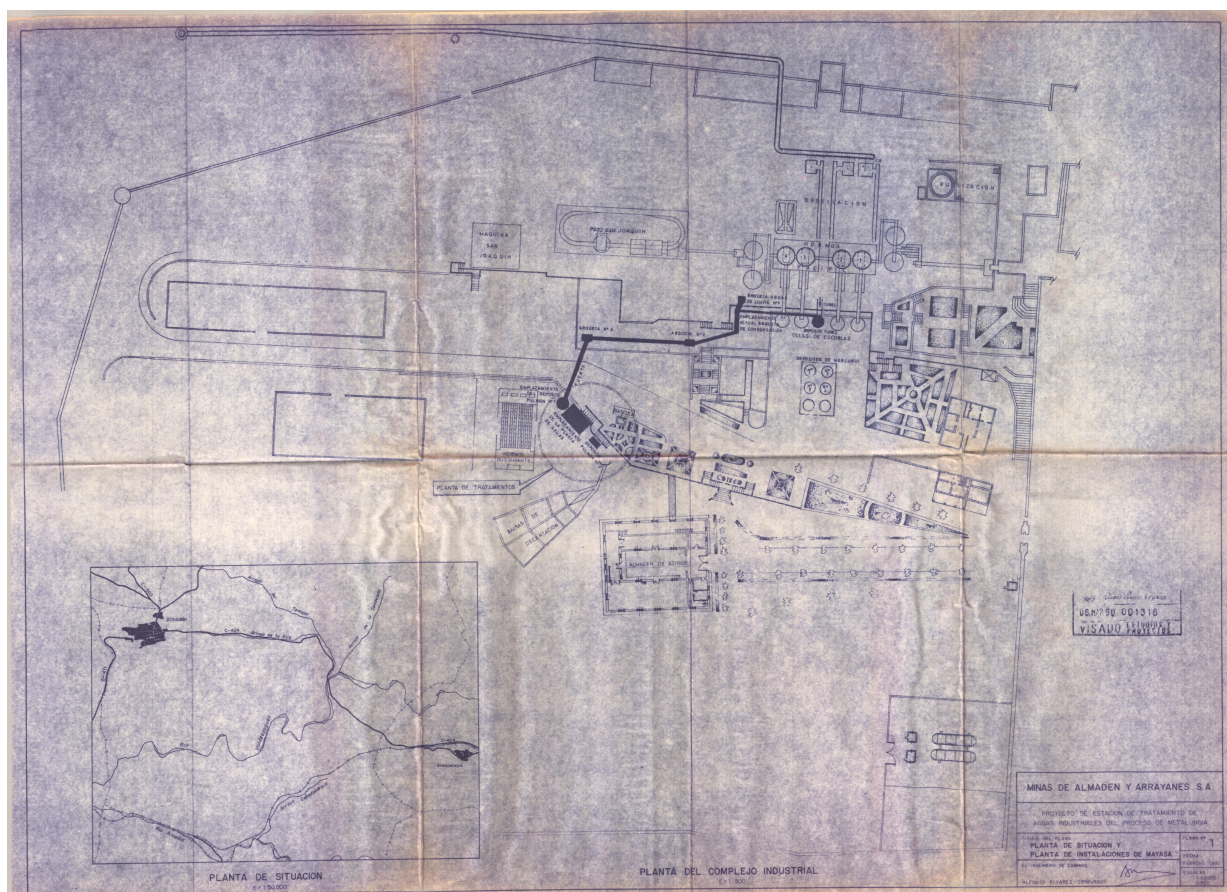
Detalle de planta de situación y planta de instalaciones de MAYASA (1990)
